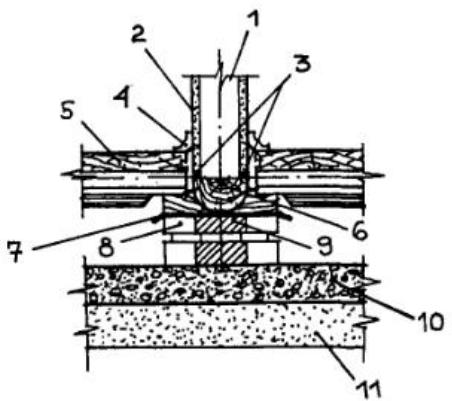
Конструкция самостоятельной перегородки: 1 — перегородка; 2 — штукатурка; 3 — бруски; 4 — плинтус; 5 — доски пола; 6 — лага; 7 — гидроизоляция; 8 — кирпичный столбик; 9 — звукоизоляционная диафрагма; 10 — бетонное основание; 11 — уплотненный грунт.
